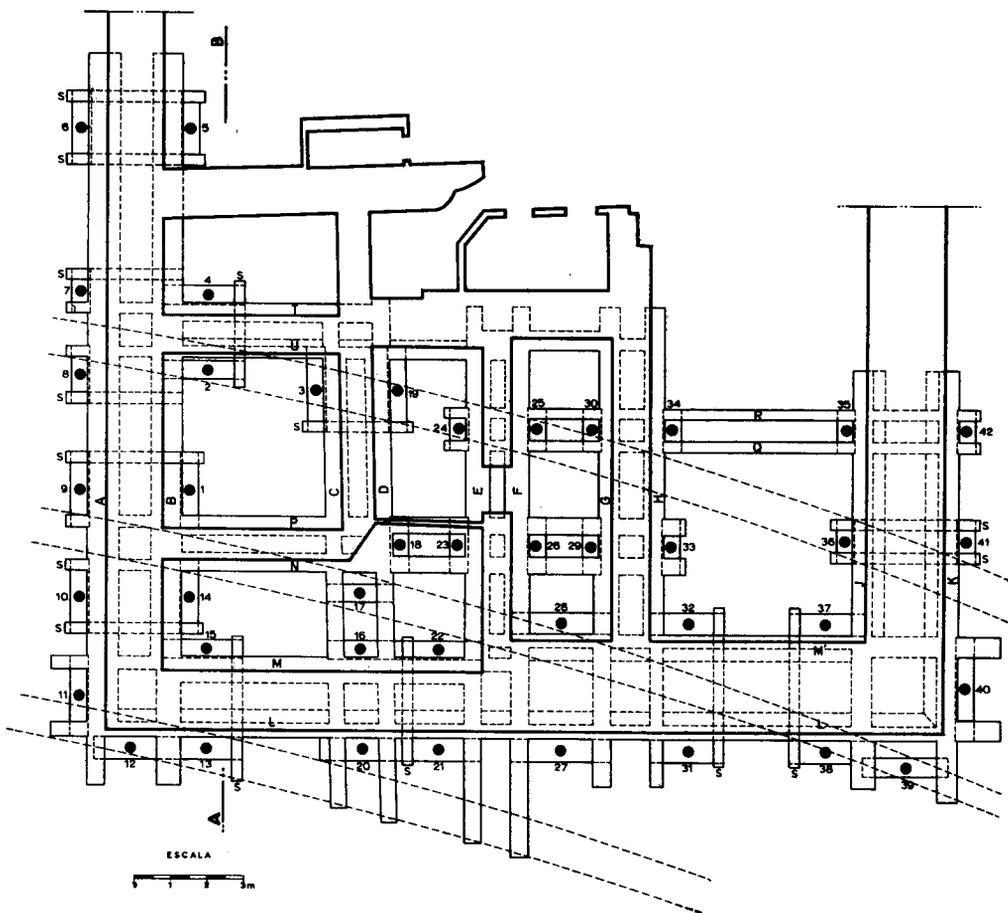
Disposição em planta das vigas e das estacas de recalçamento do edifício com frentes para a praça D. Pedro IV, rua do Amparo e praça da Figueira
